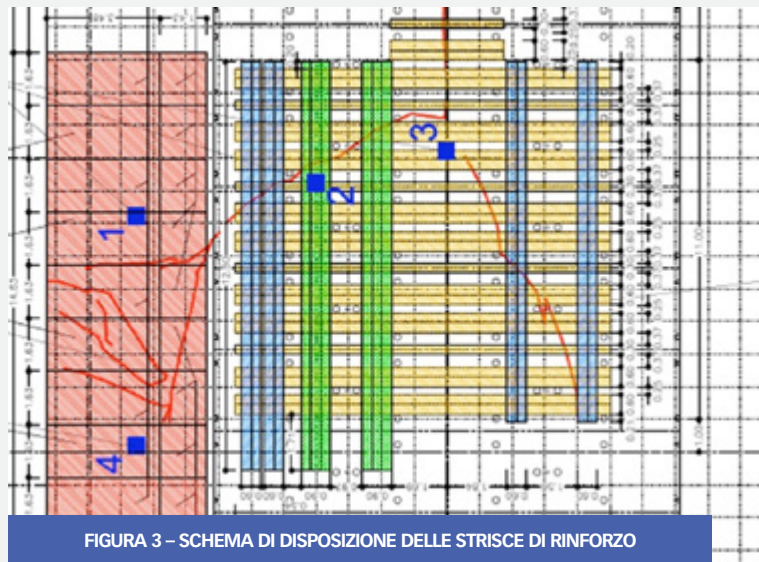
SCHEMA DI DISPOSIZIONE DELLE STRISCE DI RINFORZO
